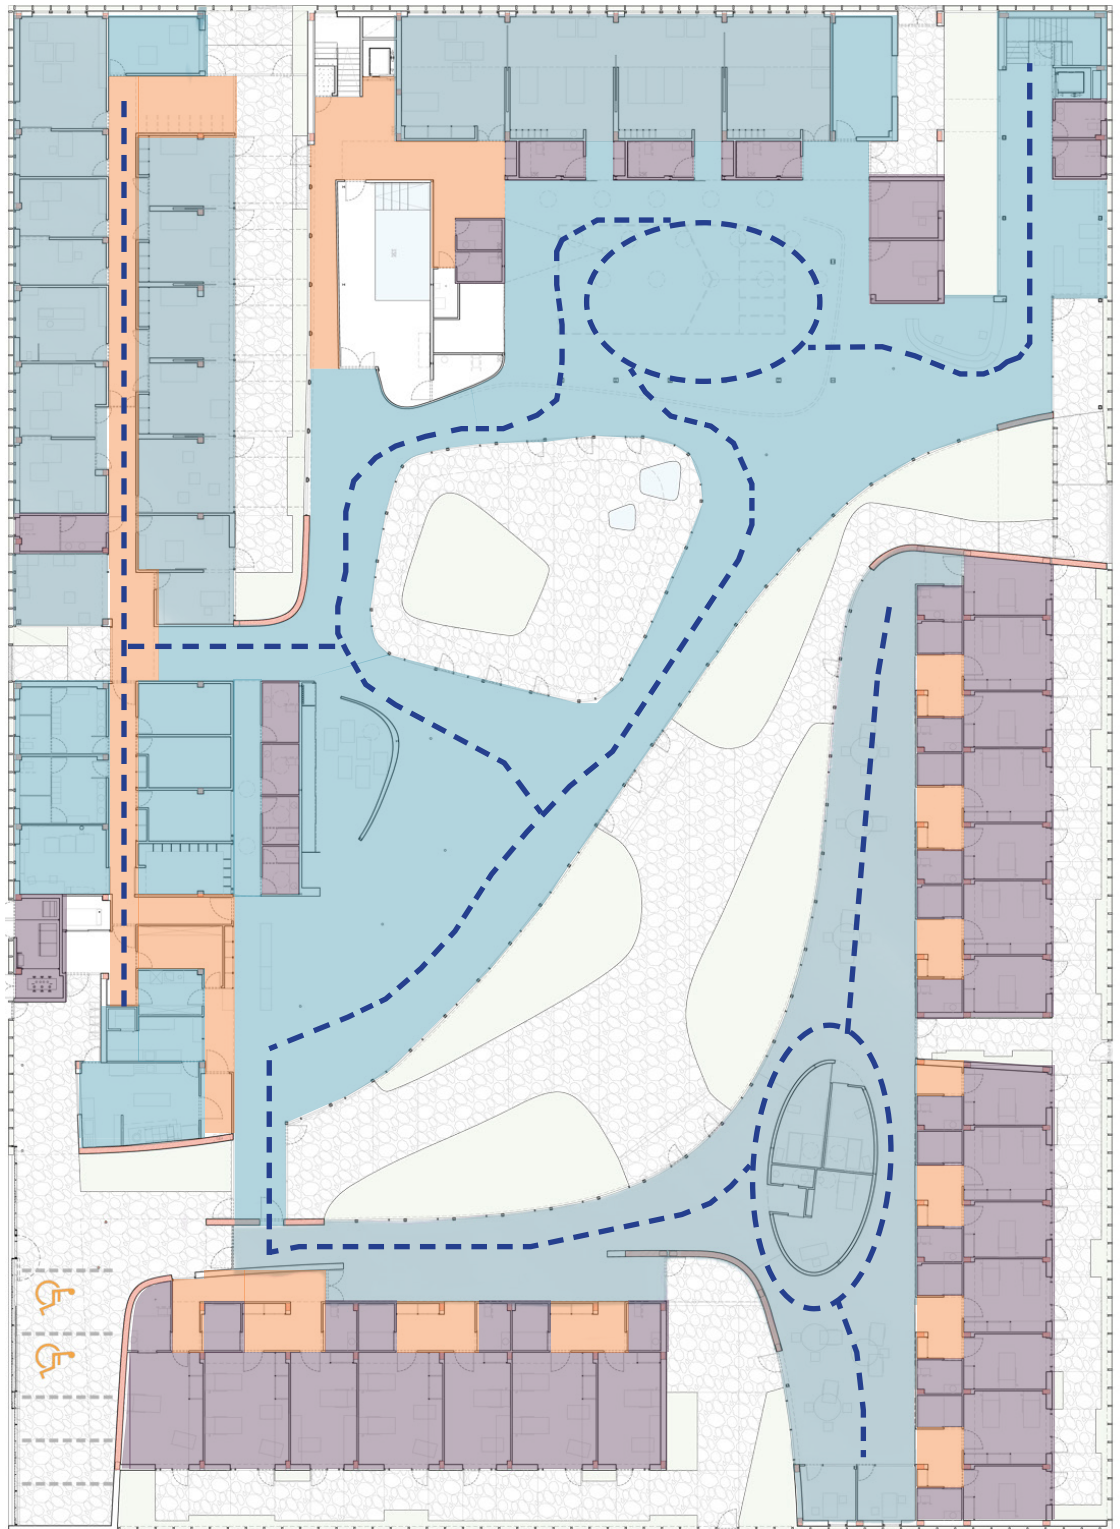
Planta baja vivienda colectiva. (Fuente: Archdaily)
